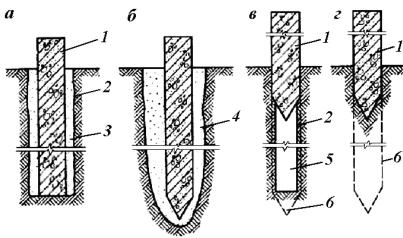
Схемы погружения свай в вечномерзлые грунты:
